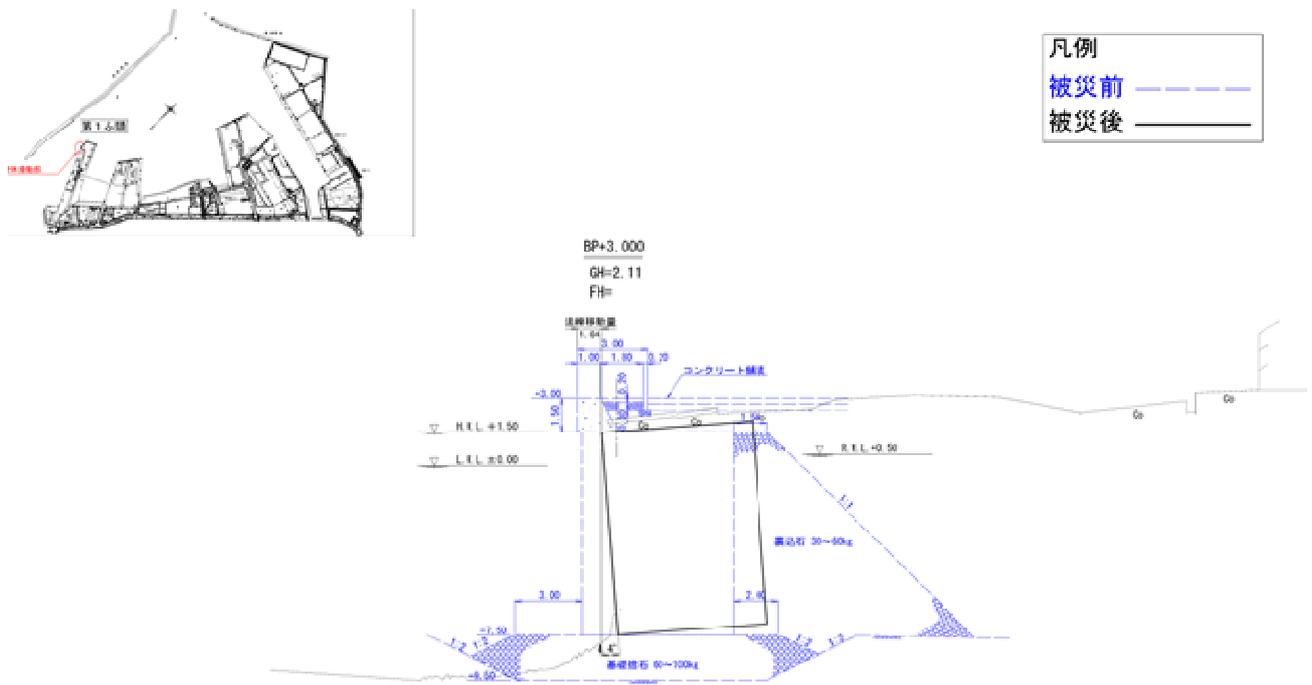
No.3 日立港区_第1ふ頭地区1-C岸壁 (-7.5m) の断面図 (被災前・後)
